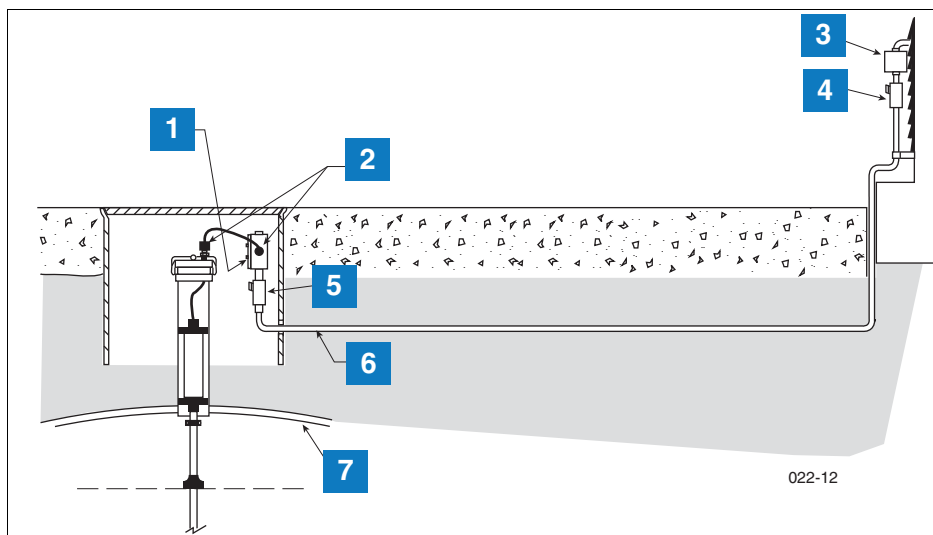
Exemplo de Instalação de Cabeamento da Sonda no Conduíte Rígido Enterrado
